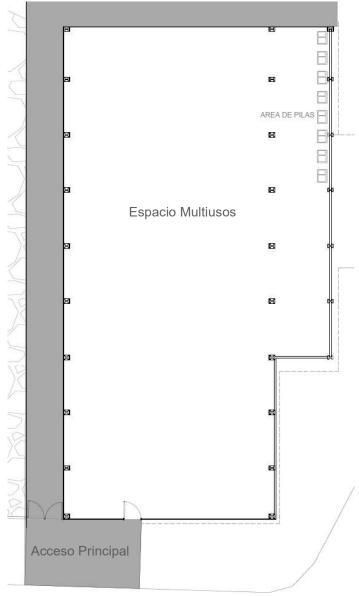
Plano distribución Arquitectónica Espacio Multiusos. Elaboración propia
